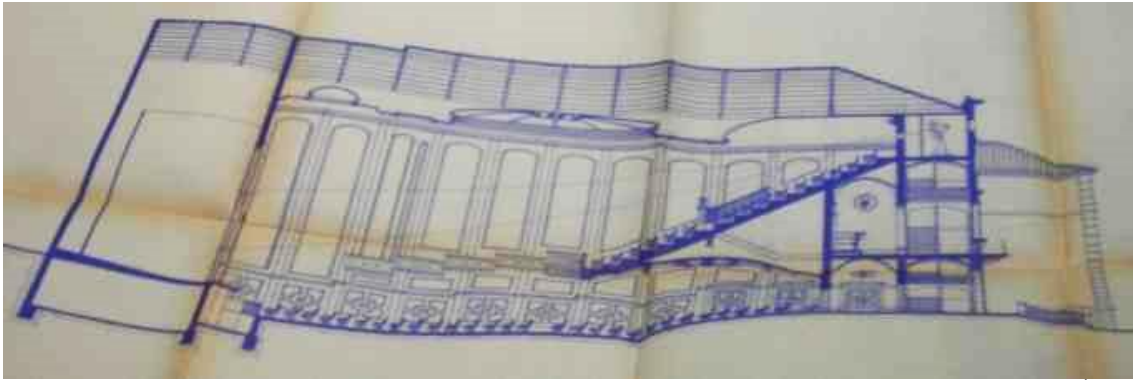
Plano de la sección longitudinal reformada del Teatro Romero de Plasencia (GARCÍAS PABLOS, R., 1948).
